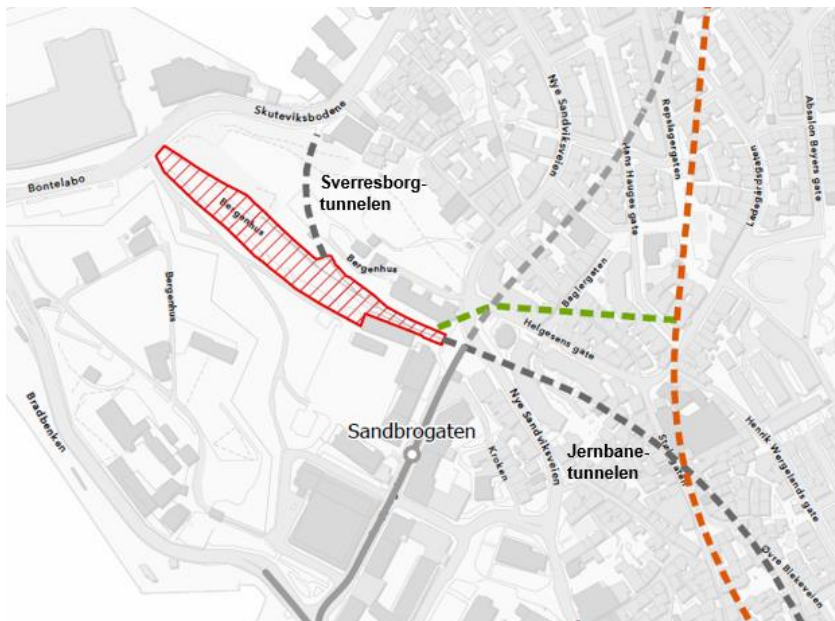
Oversiktstegning alternativ T1. Anleggstunnel fra Koengen til tunnelalternativet vist med grønn stiplet linje.
